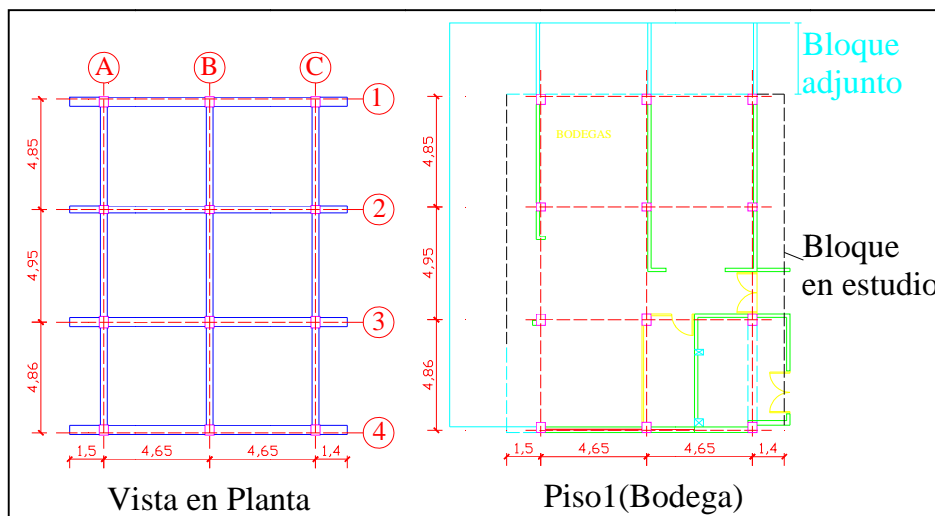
Vista en Planta General y Vista en Planta (Piso1).
